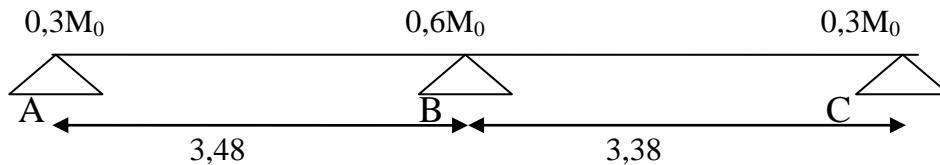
Schéma statique de la poutrelle continue reposant sur 3 appuis
